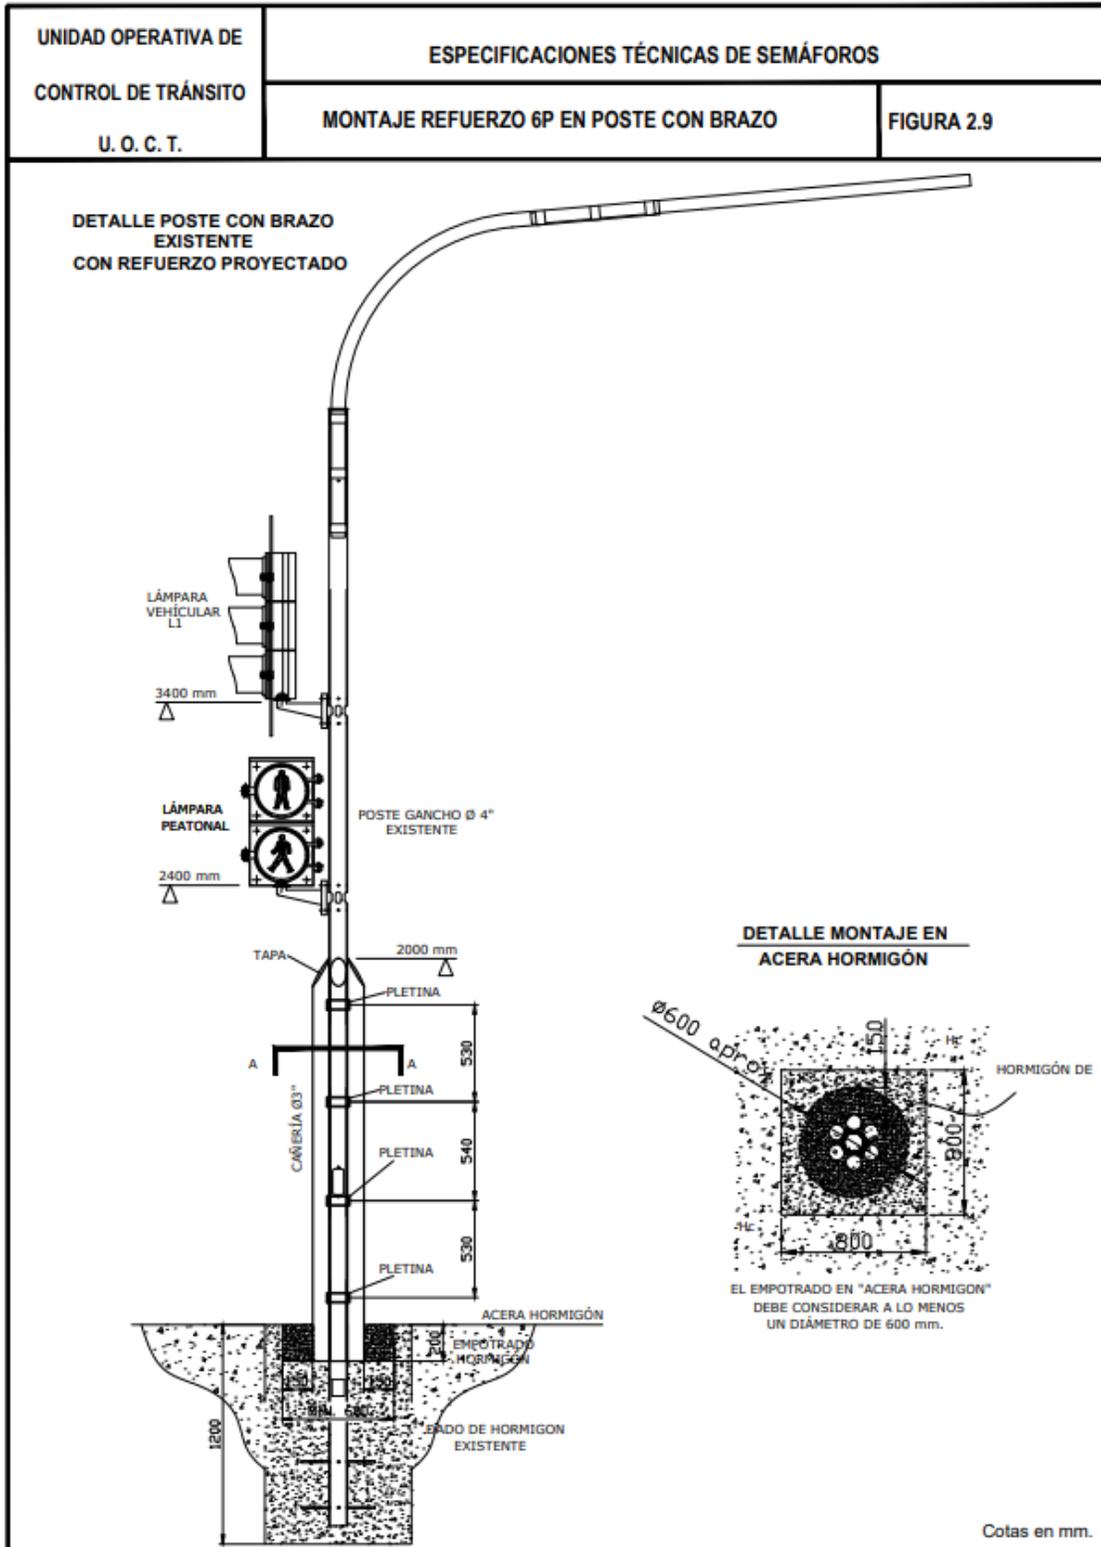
9 Montaje refuerzo 6P en poste con brazo
